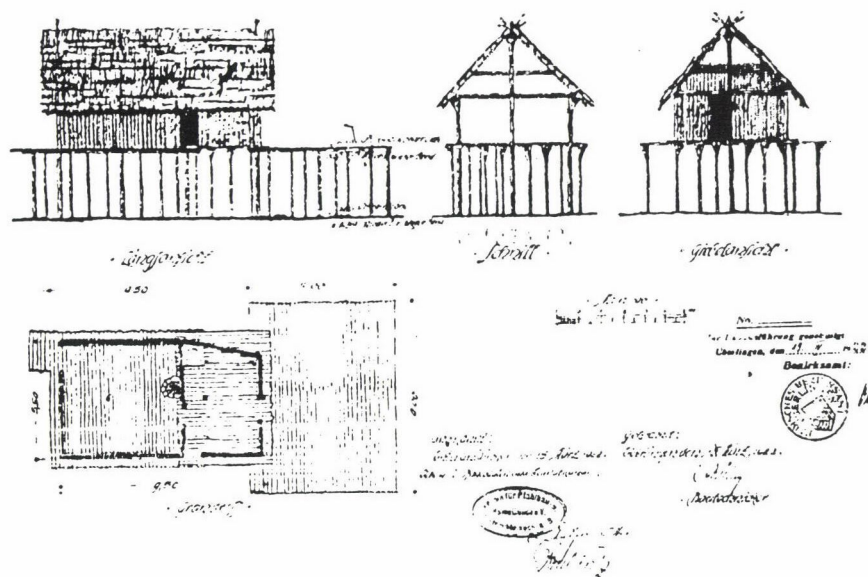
Planunterlagen zum Baugesuch für Pfahlbaumuseum Unteruhldingen, 1922 (nach Schöbel)
